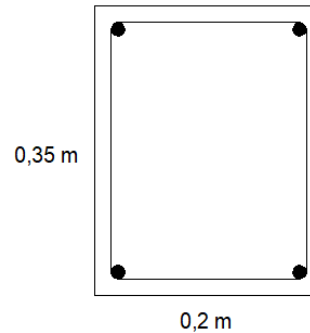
dan 11 menampilkan detail elemen struktur menara air, termasuk balok, kolom, dan *shear wall*, sehingga konfigurasi dan hubungan antar komponen dapat dipahami dengan lebih jelas dalam mendukung kekuatan dan kestabilan bangunan.
